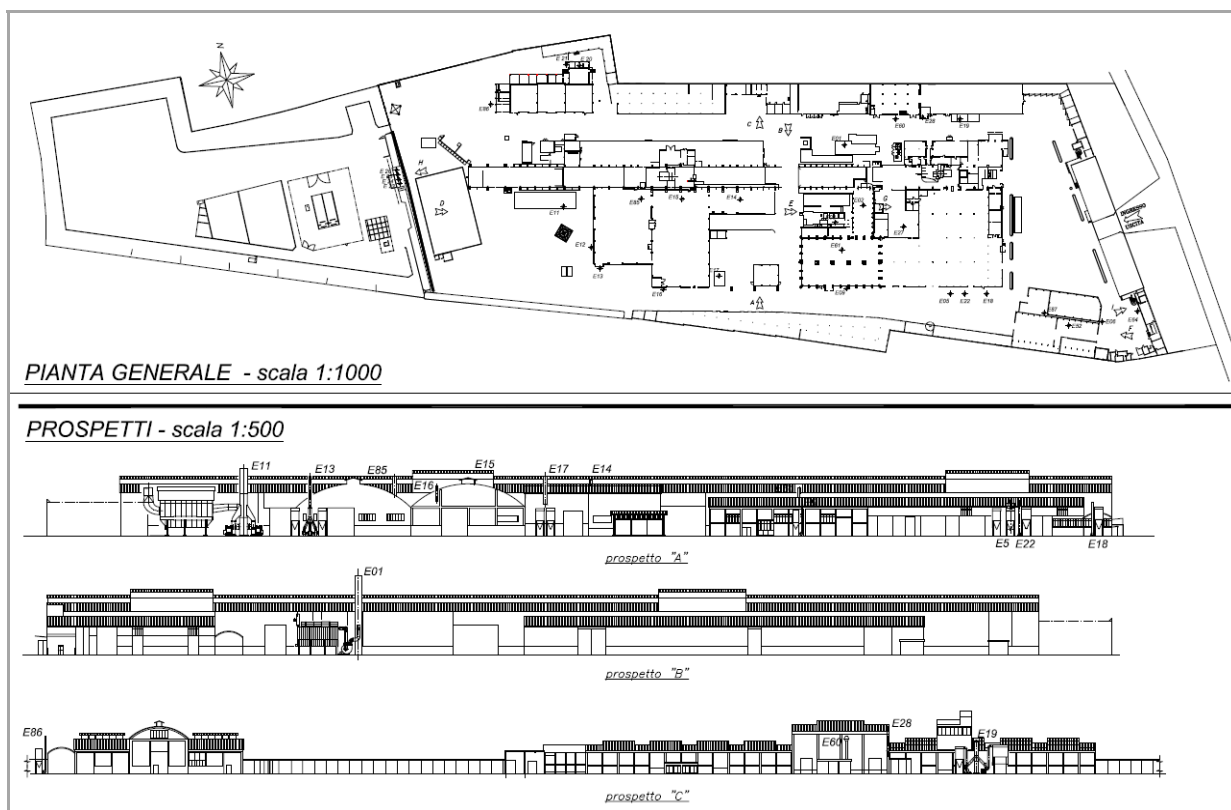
Layout e prospetti dello stabilimento Pometon S.p.A. di Maerne
